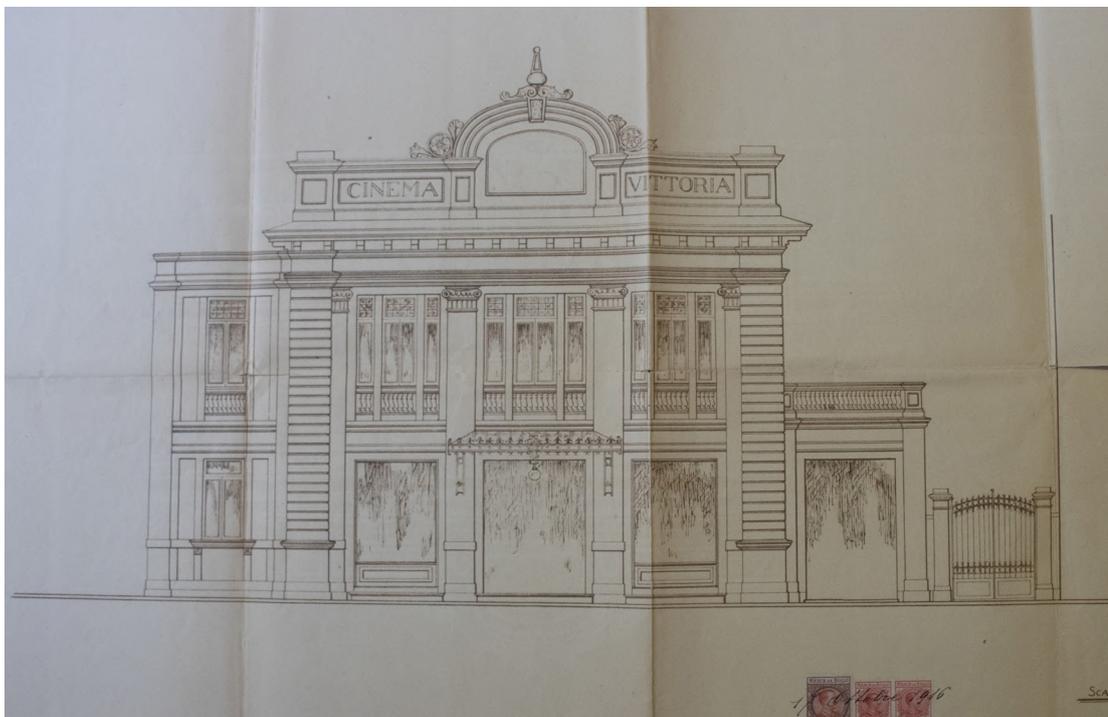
Disegno del progetto del prospetto originale del cinema Vittoria. Fonte: Archivio comunale di Varese.
